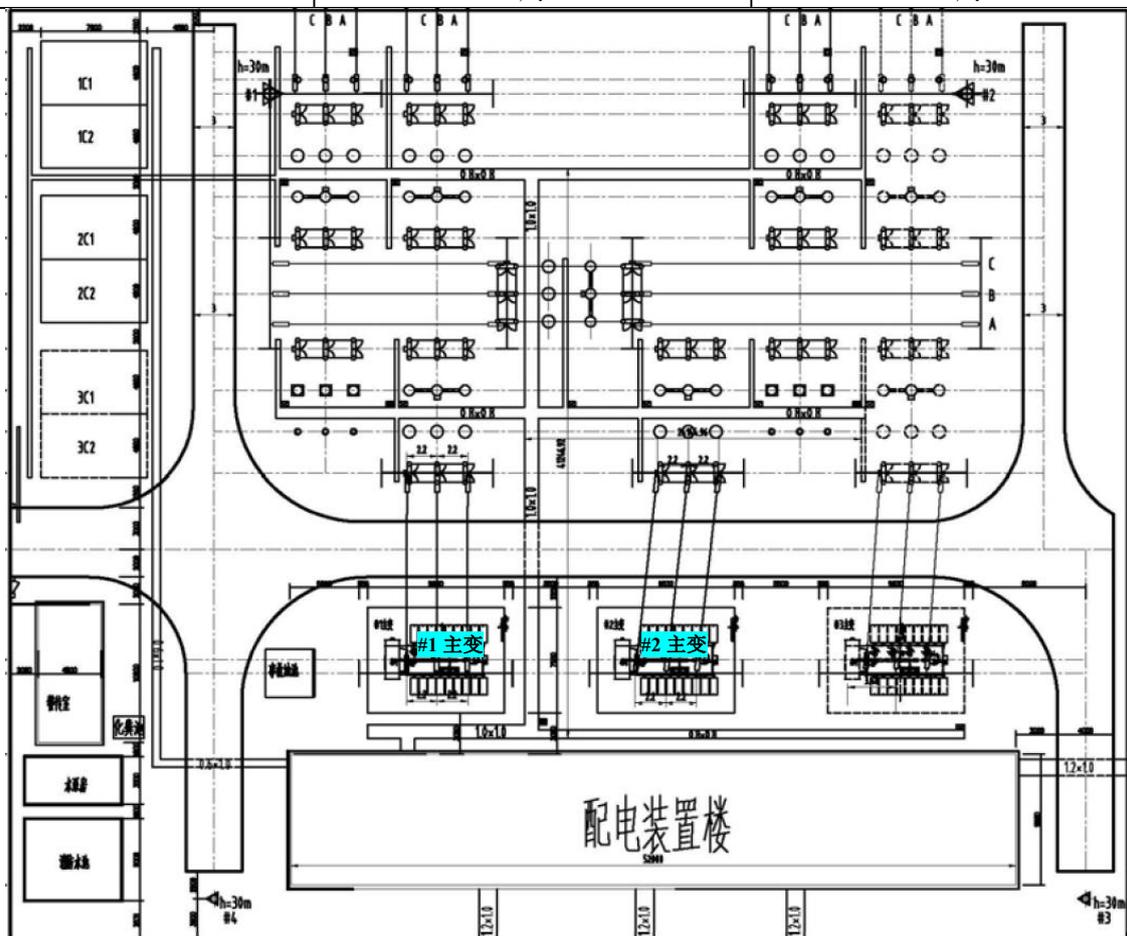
110 千伏银河（白沙二）站总平面布置示意图
